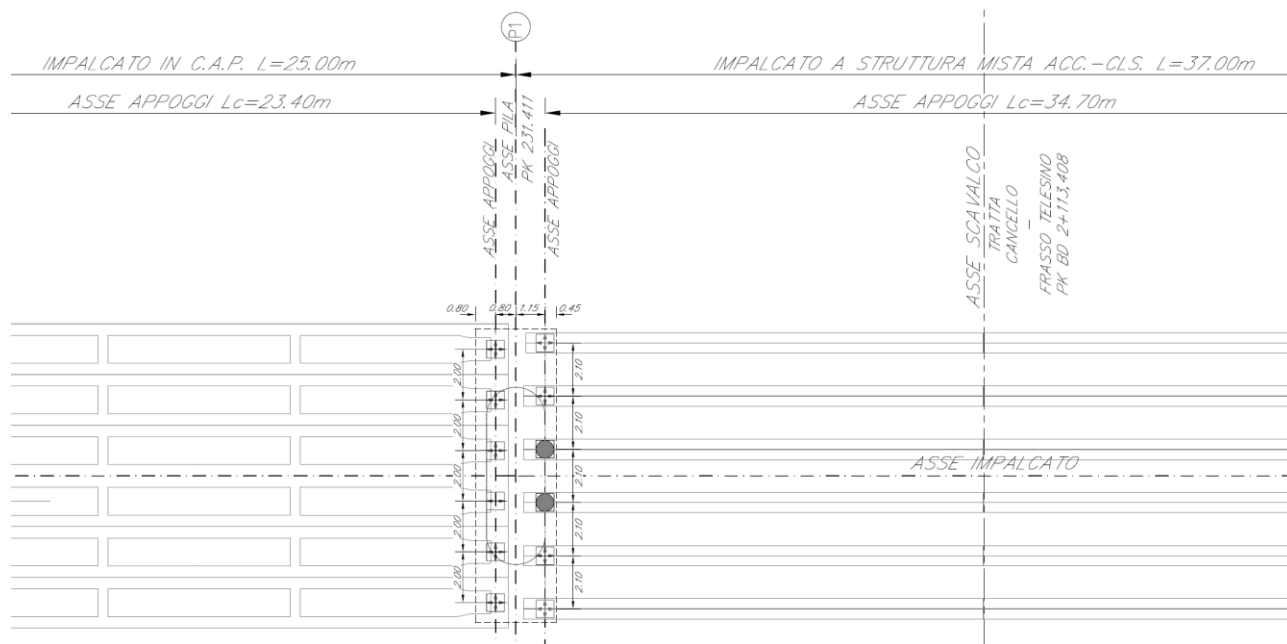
Pila 1 - Schema dei dispositivi di appoggio
